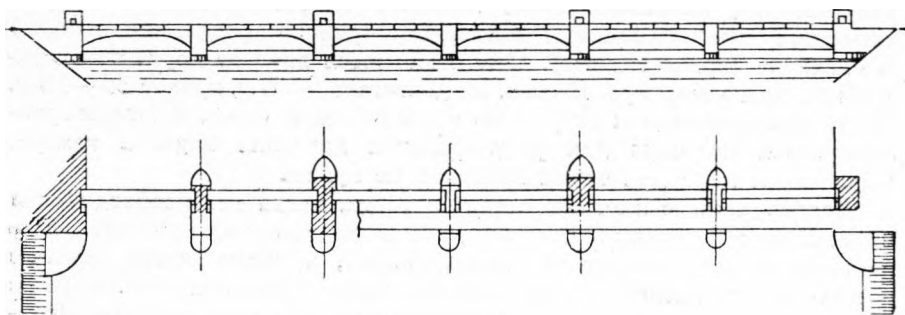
Схематический план и фасад плотины с вальцовыми затворами.
